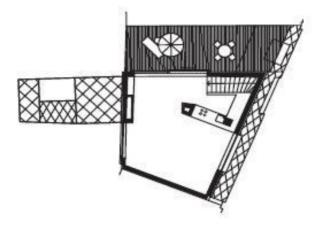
Planta Arquitectónica del sexto nivel con uso habitacional.
